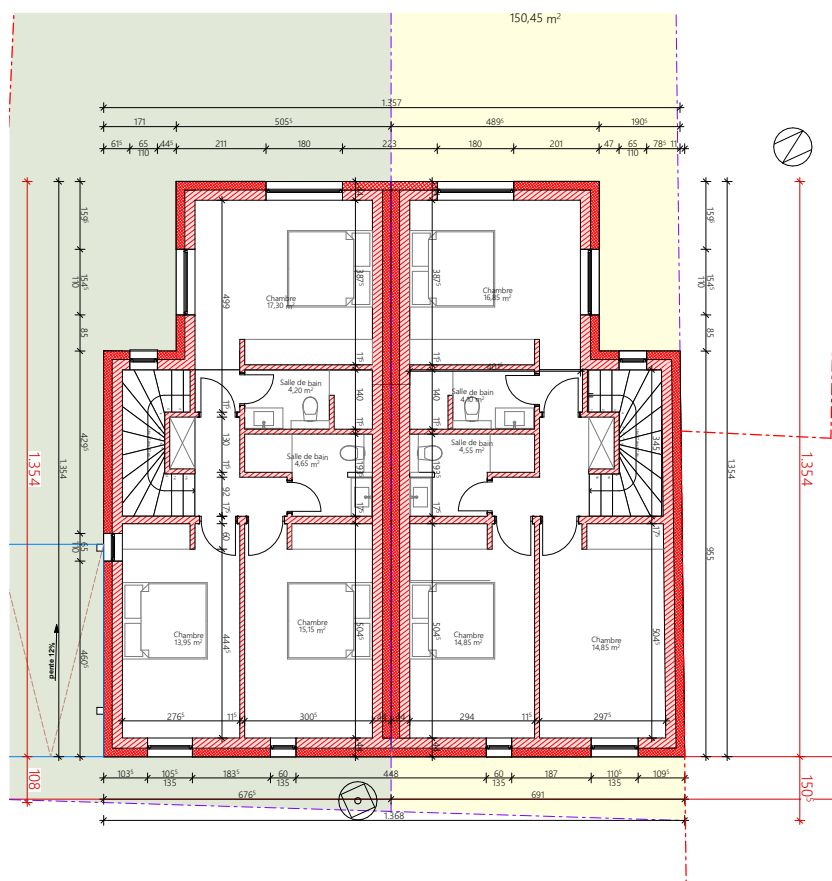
Grundriss 2. Obergeschoss Mehrfamilienhaus
